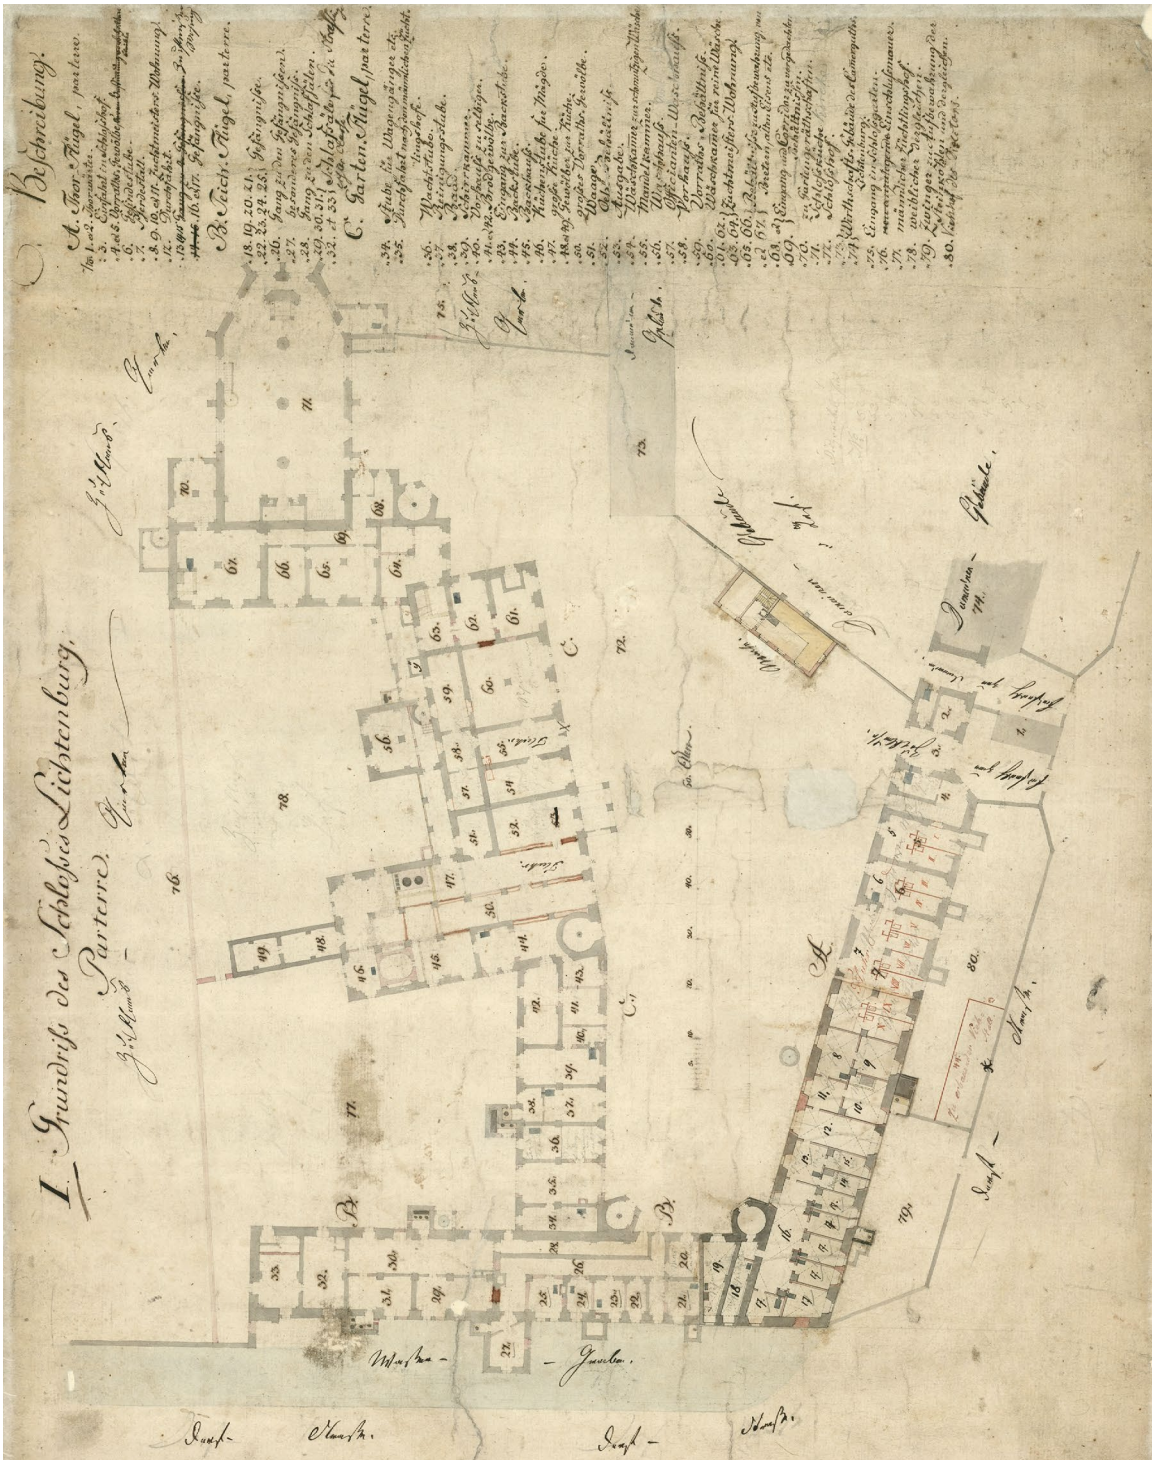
Prettin, Schloss Lichtenburg, Erdgeschoss, Grundriss, 1810–1812. LASA Merseburg, C 48 IX, Lit. K Nr. 33
